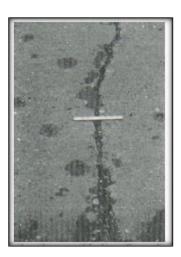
Grietas lineales de severidad media en losa de concreto reforzado
